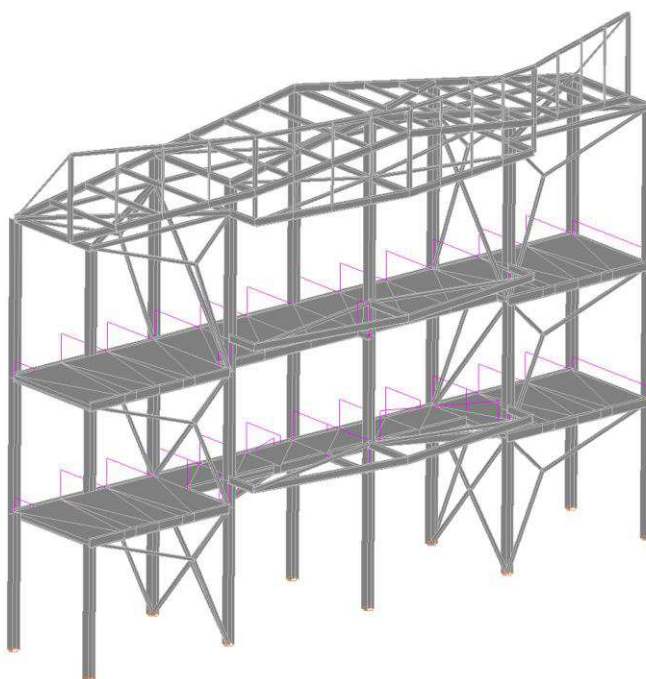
Нагрузка на каркас от полезной нагрузки
